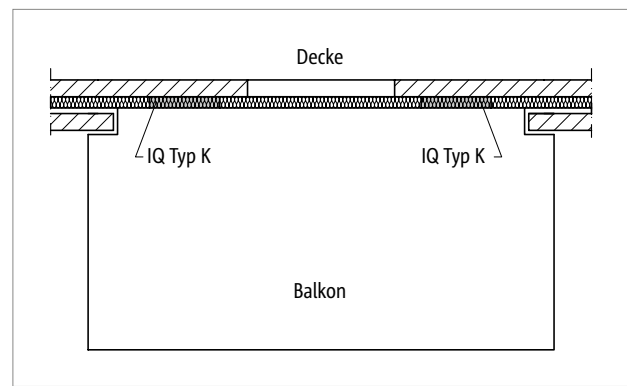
Schöck Isokorb® IQ Typ K-A/B: Anschluss bei zweischaligem Mauerwerk
